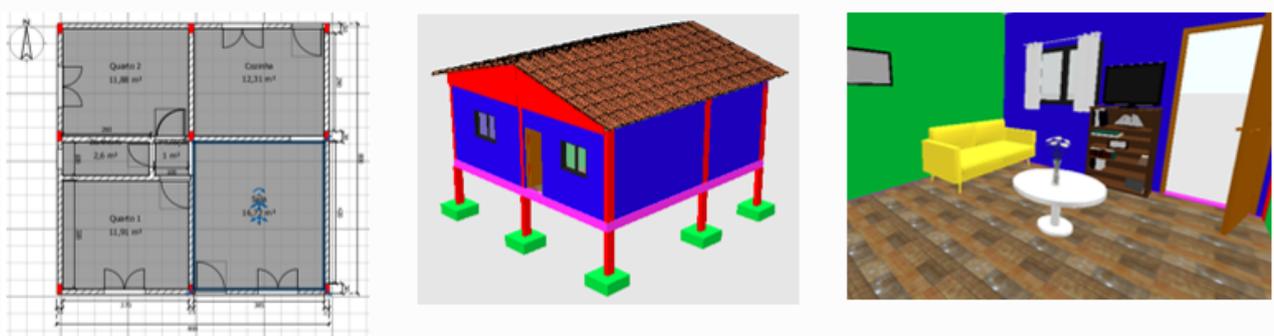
Planta baixa, visão 3D e vista interior de uma casa gerados no Sweet Home 3D.
